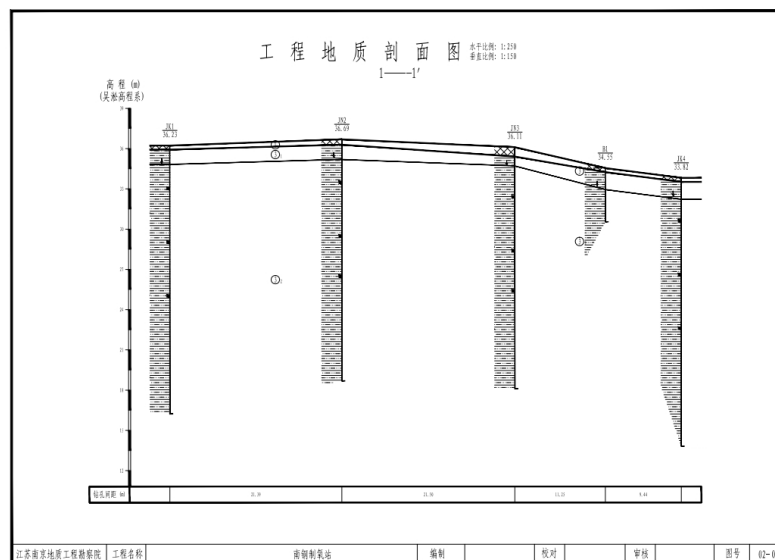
项目拟建厂址范围工程地质剖面图
